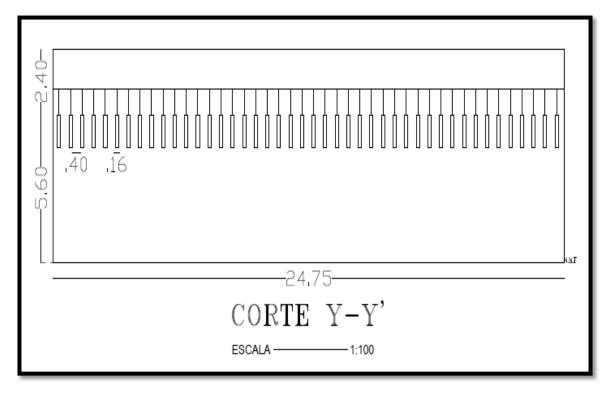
Corte en la sección y de las instalaciones del CCICEV para establecer disposición, dimensiones y espaciamiento entre los paneles
